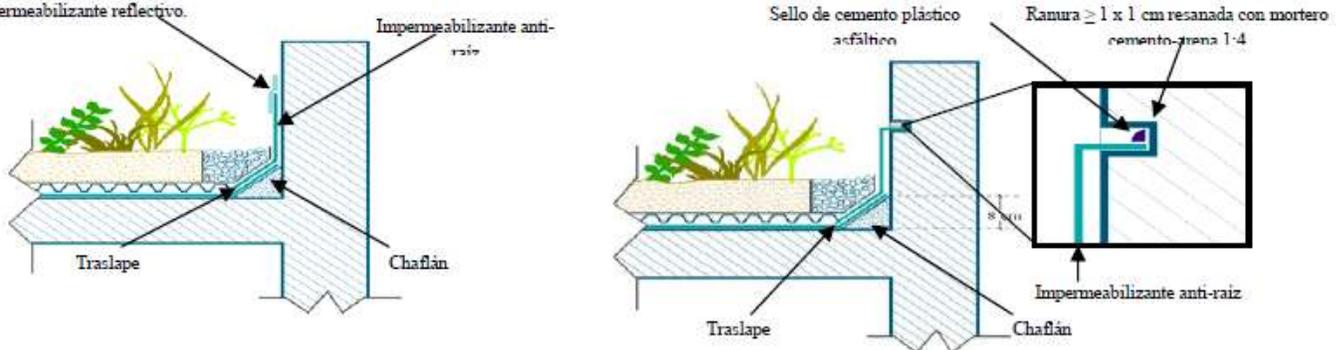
Impermeabilización con membrana prefabricada asfáltica en puntos de encuentro con pretilas y elementos emergentes perimetrales.
